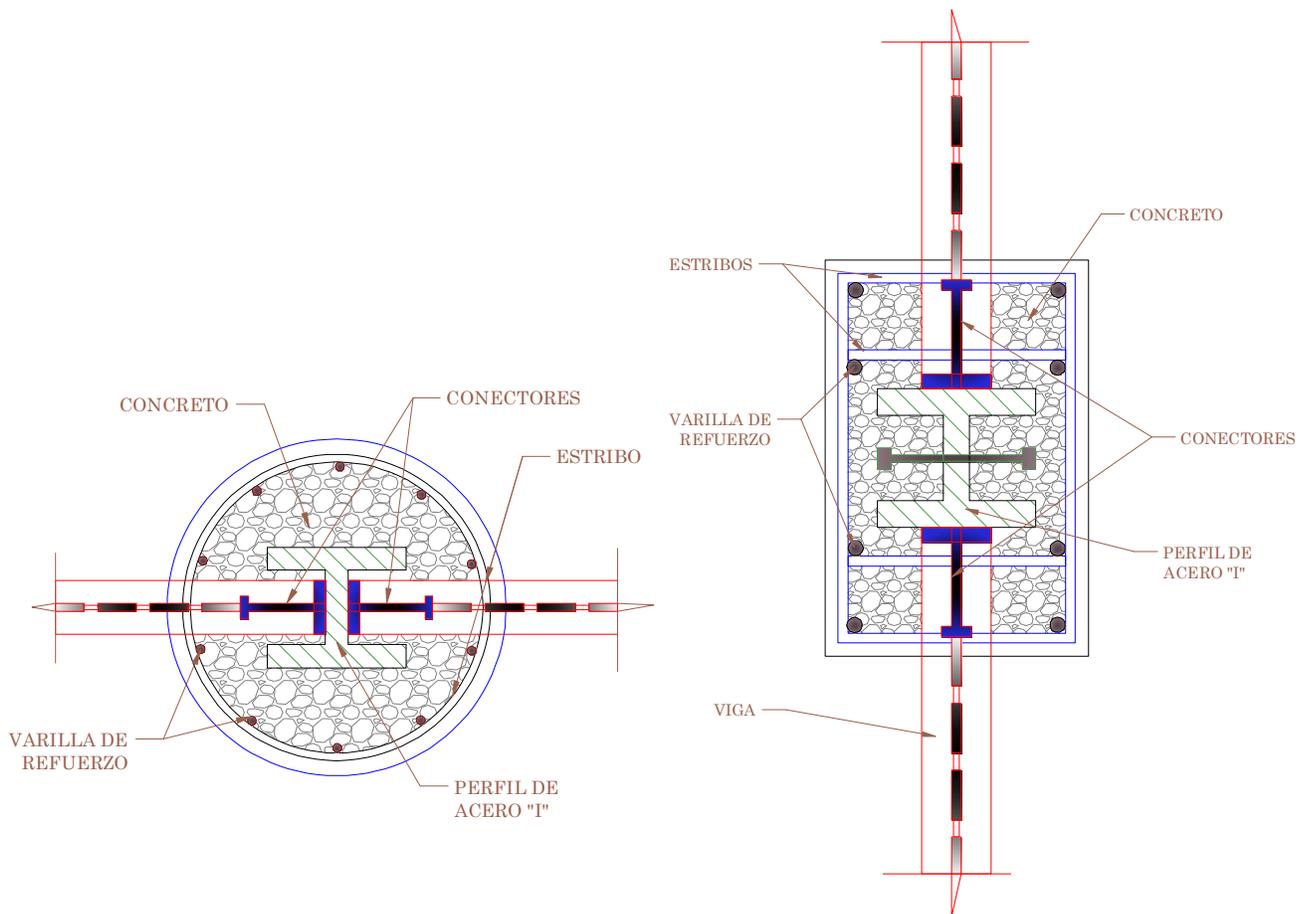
Detalle de la sección de una columna empleando acero estructural, un perfil I, para dar mayor resistencia a la estructura.
